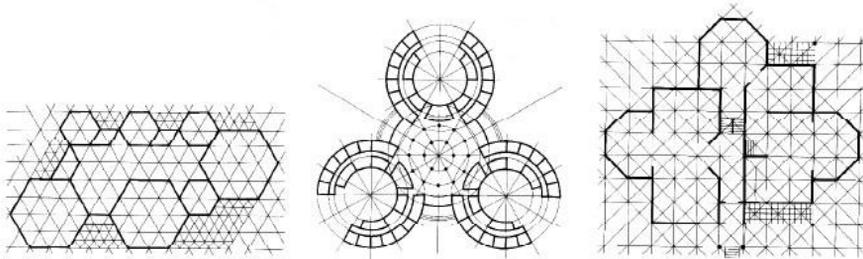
Использование модульных сеток в формировании планов зданий
